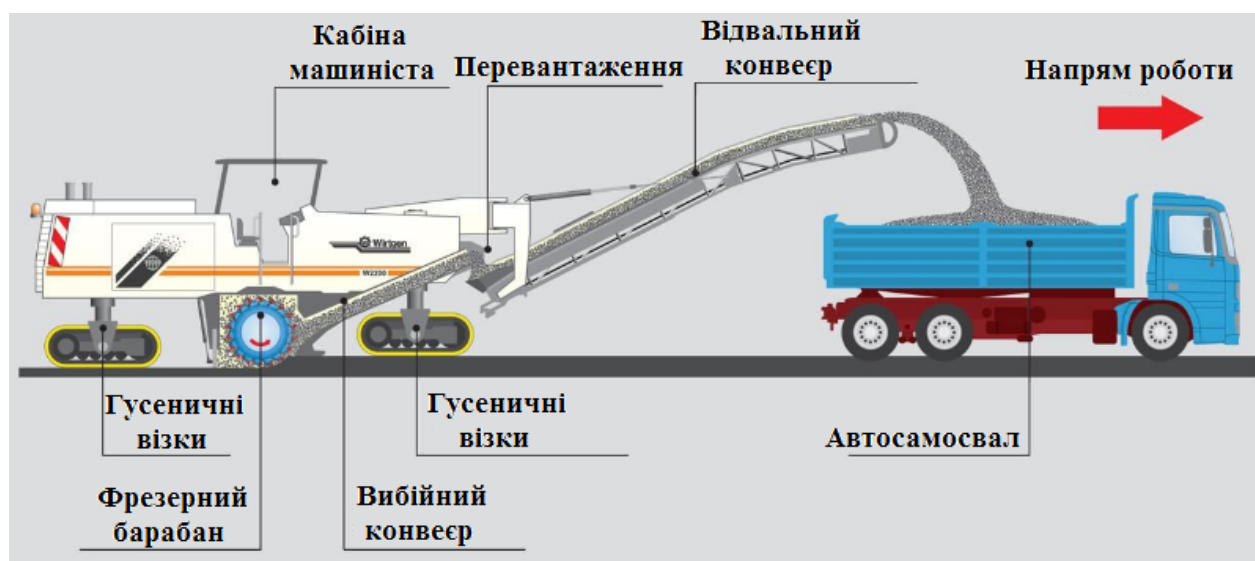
Схема видобутку корисної копалини фрезерним екскаватором
